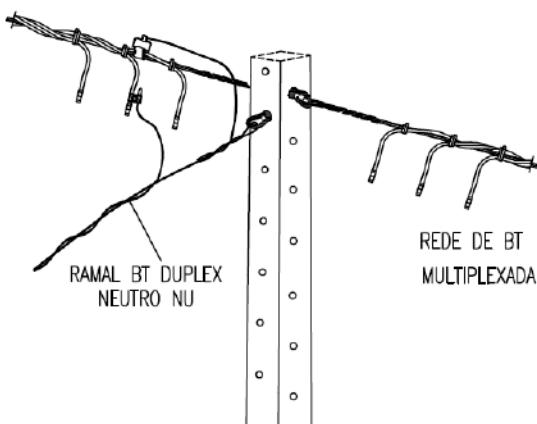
Amarrações e ligações – Secundário – ligação dos ramais de serviço padrão – existente
